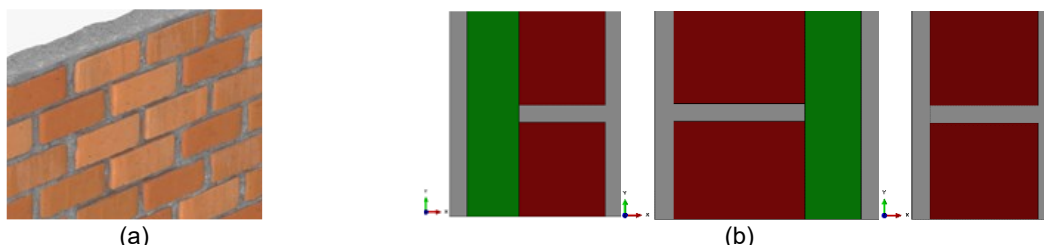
(a) Conjunto de parede genérico, e (b) geometria adotada para betão/alvenaria (cinza-argamassa, verde-isolamento e vermelho-núcleo principal).
